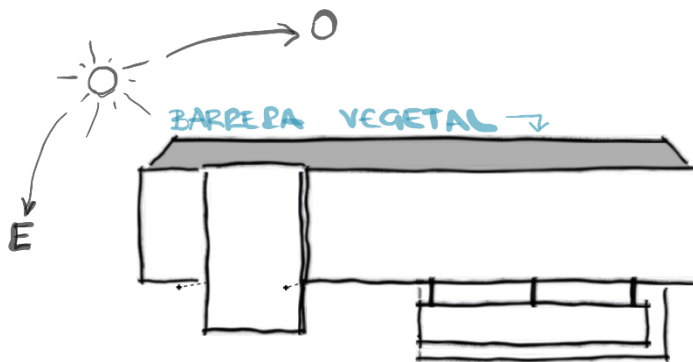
Vista en planta de un modelo 3D de la Container Guest House. Elaboración propia.
